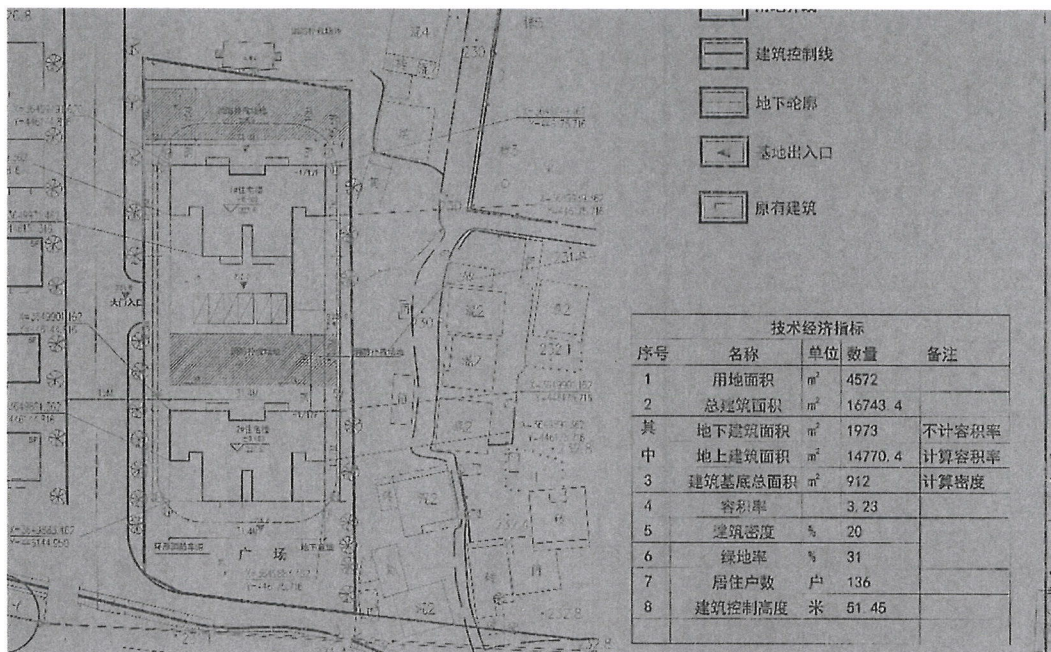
佘家湾 1#地块安置房总平面布置图及技术经济指标
